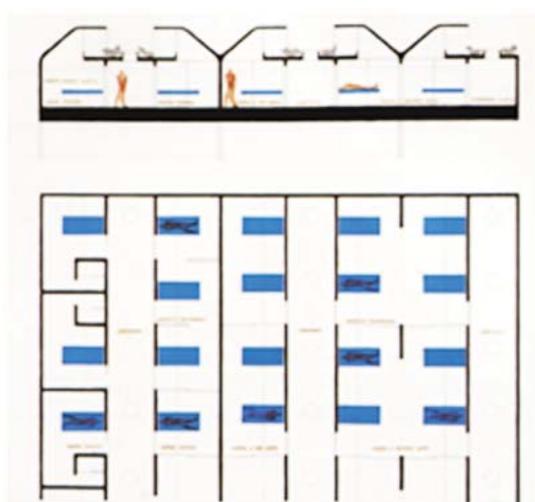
Planta y Sección de las Unidades de Habitación (O'Byrne)
